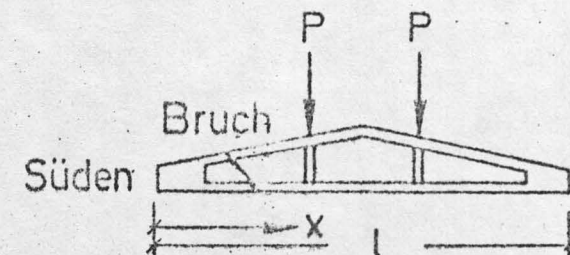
Verlauf der Betonstauchung in Balkenlängsrichtung
